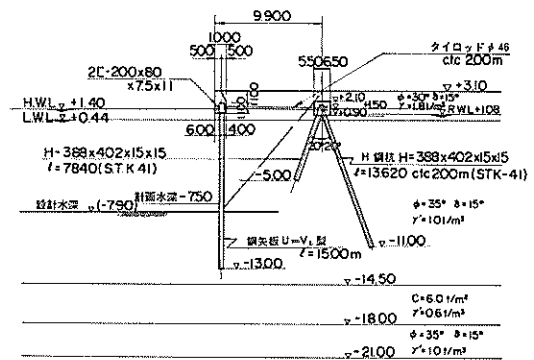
仙台港フェリーふ頭第2バース (-7.5 m) 標準断面図
